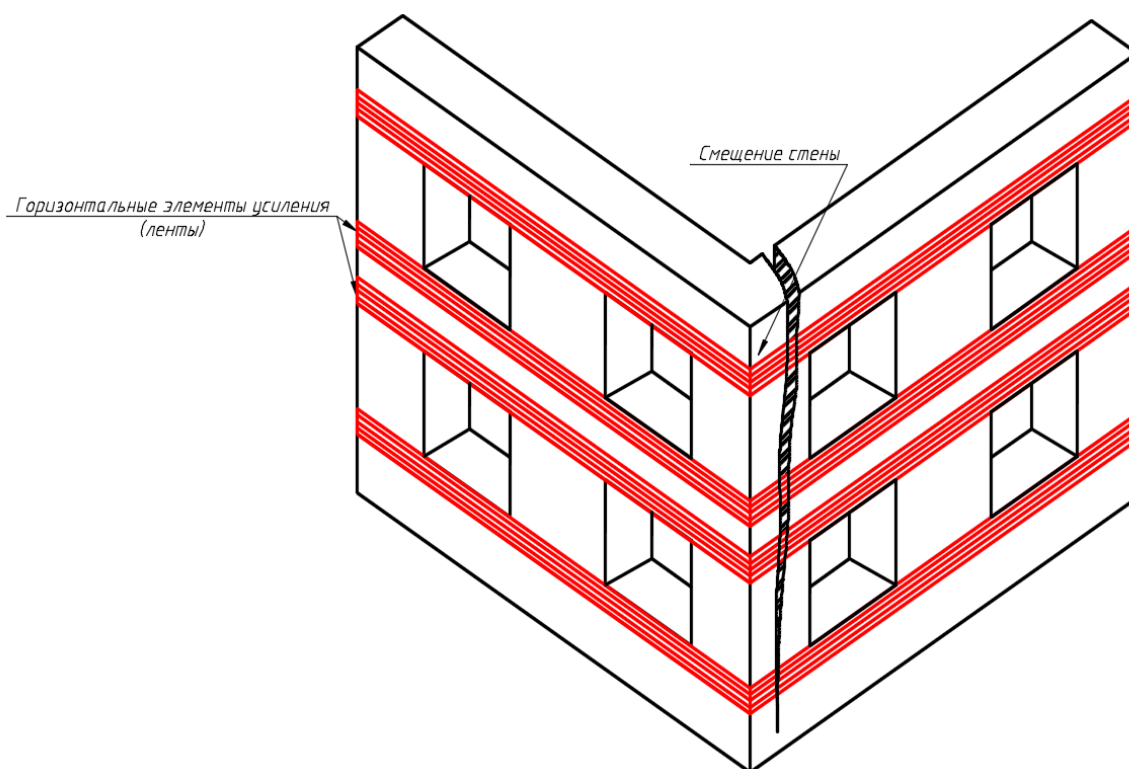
Усиление здания при разрушении сопряжения торцевой стены и основной части путем устройства поясов/затяжек из углеродных лент/тканей
